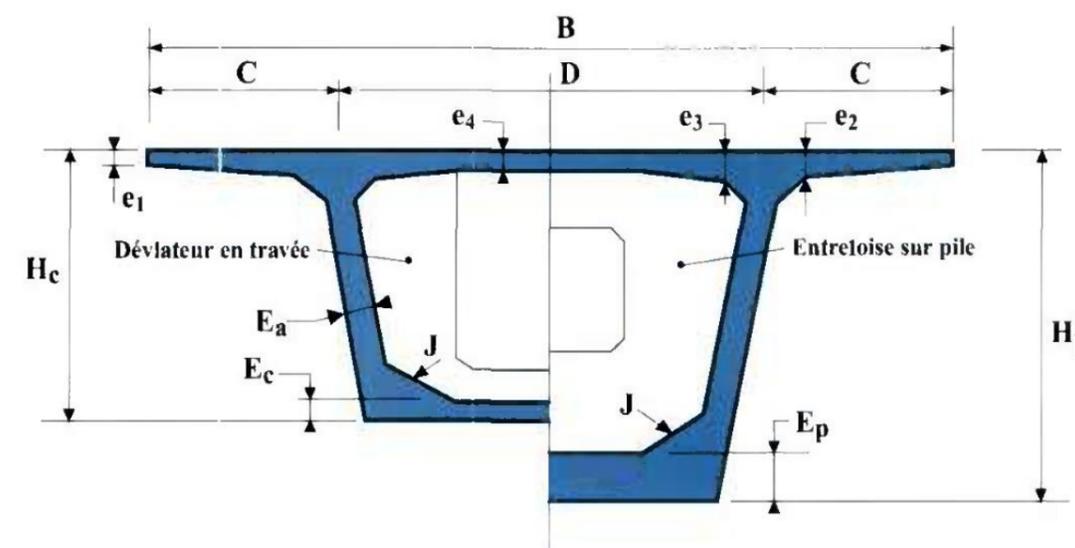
Coupe transversale type d'un caisson en béton précontraint
